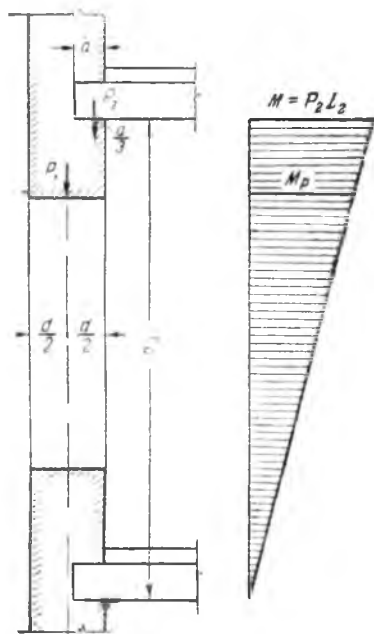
Эпюра моментов от перекрытия в стене без обреза
